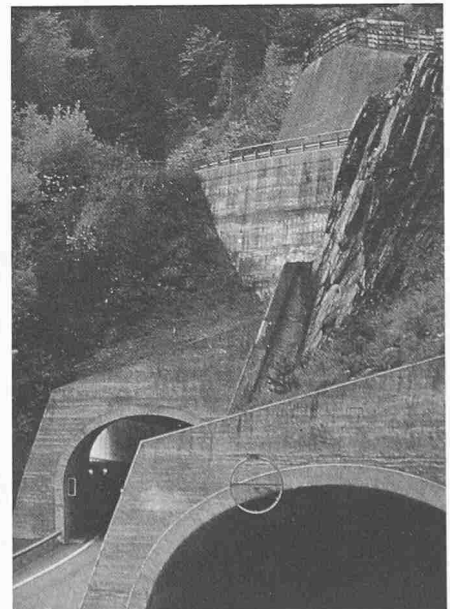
Schlecht angelegte Strasse. Auffüllung, Abgrabung
